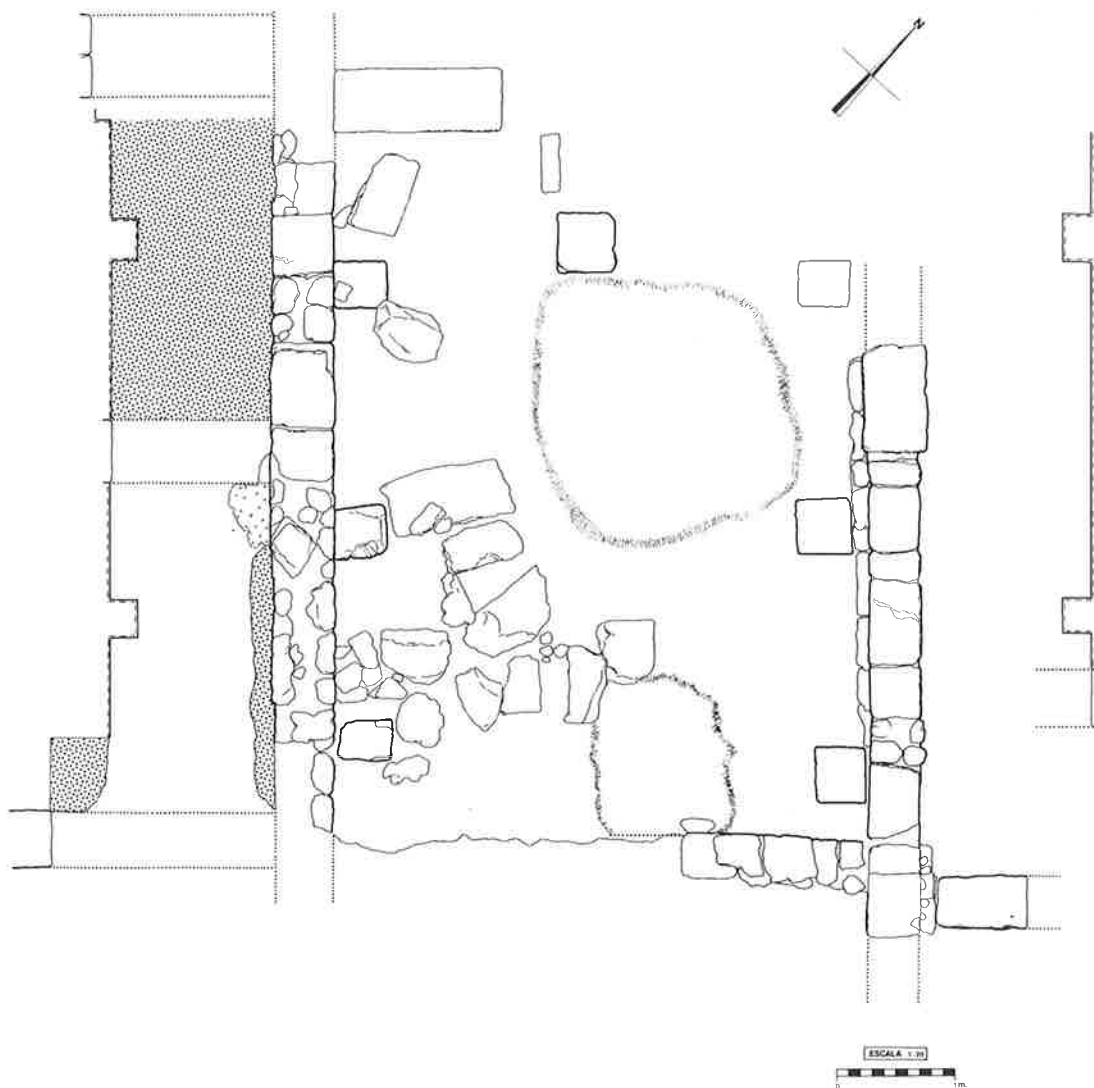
Planta general de la Casa Palacio de los Pardo en la zona de estructuras arquitectónicas.
